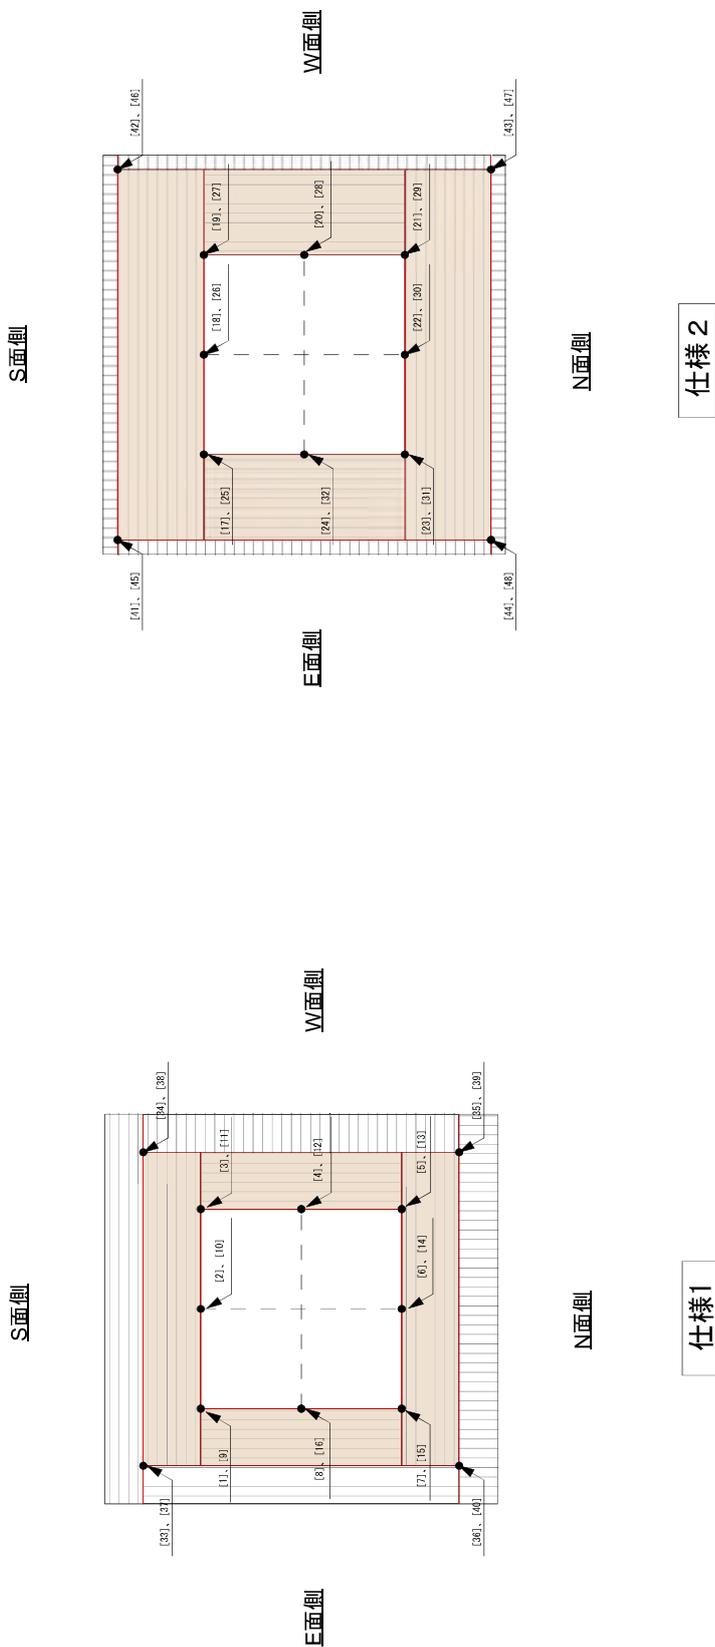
試験体Aの構造・内部温度測定位置(寸法単位:mm)
